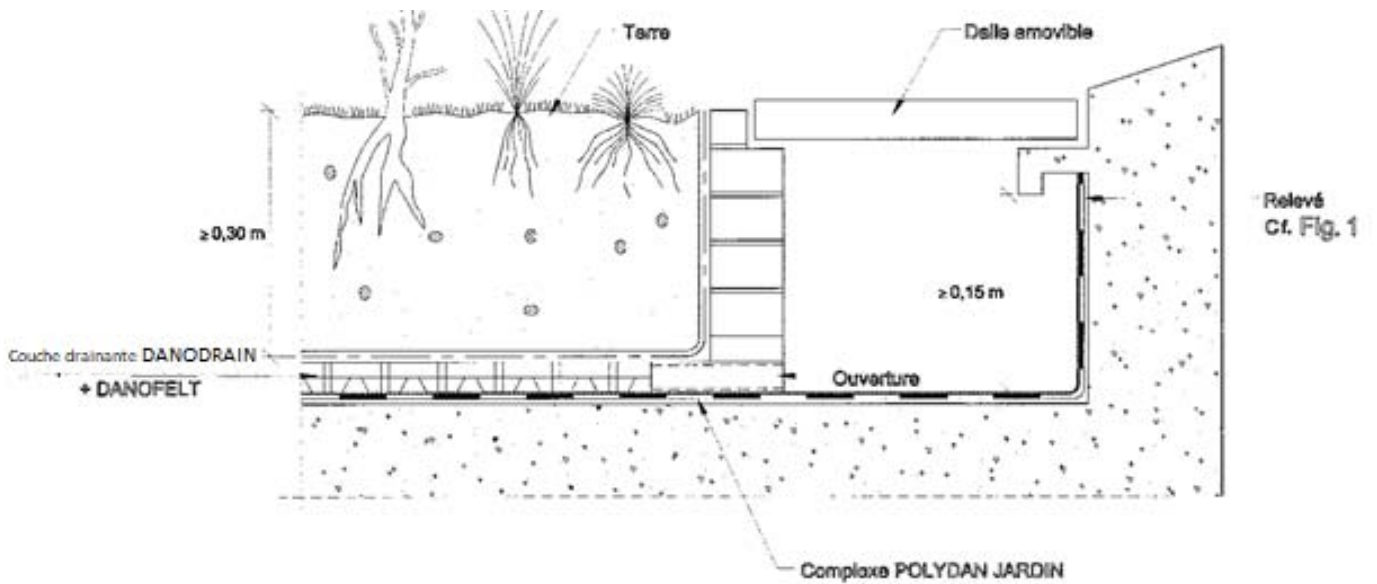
Exemple d'aménagement de la zone stérile contre le relevé – Toitures-terrasse-jardin - Élément porteur en maçonnerie uniquement (Cf. paragraphe 2.4.8.6)
